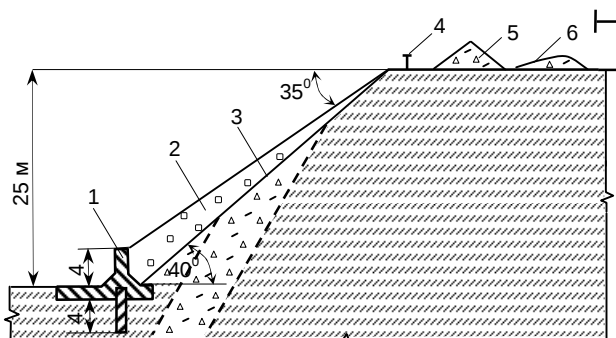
Поперечный разрез укрепленного откоса уступа: 1 - железобетонная подпорная стенка на свайном фундаменте; 2 - скальная засыпка в застенном пространстве, расположенная под углом естественного откоса; 3 - поверхность откоса; 4 - репер наблюдательной станции; 5 - оградительный вал; 6 - автодорога
